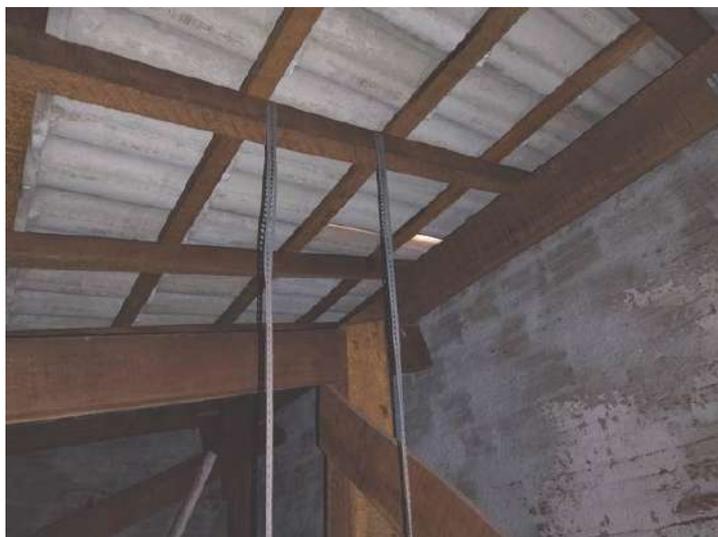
Cobertura – Má fixação/travamento de eletrodutos
